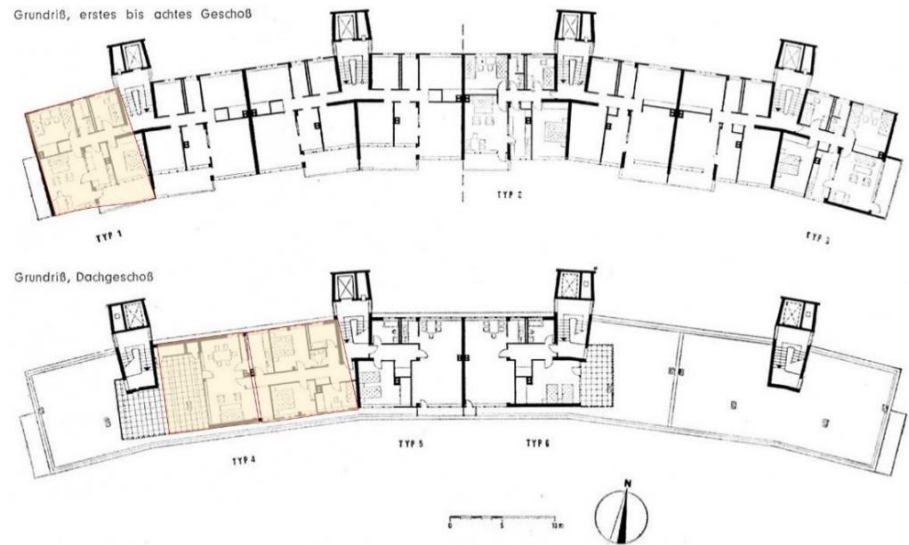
projeto Walter Gropius para Hansaviertel, Berlin
